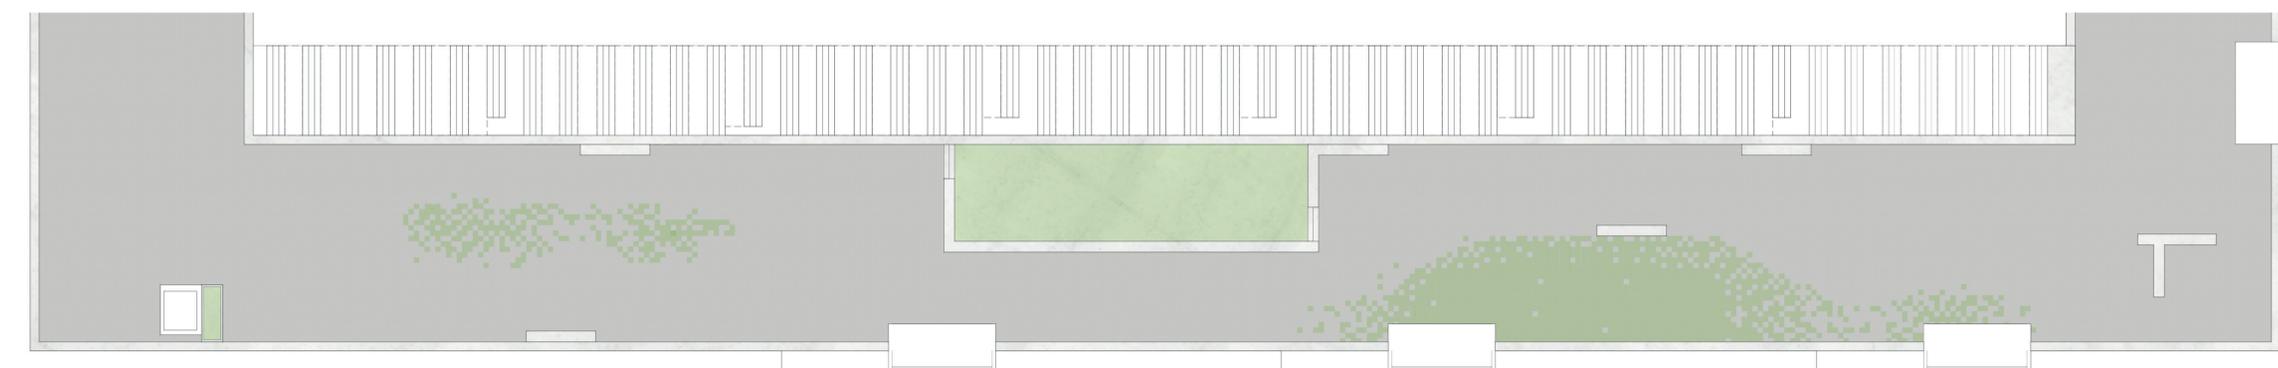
Westflügel Dachdraufsicht 1 - 250
